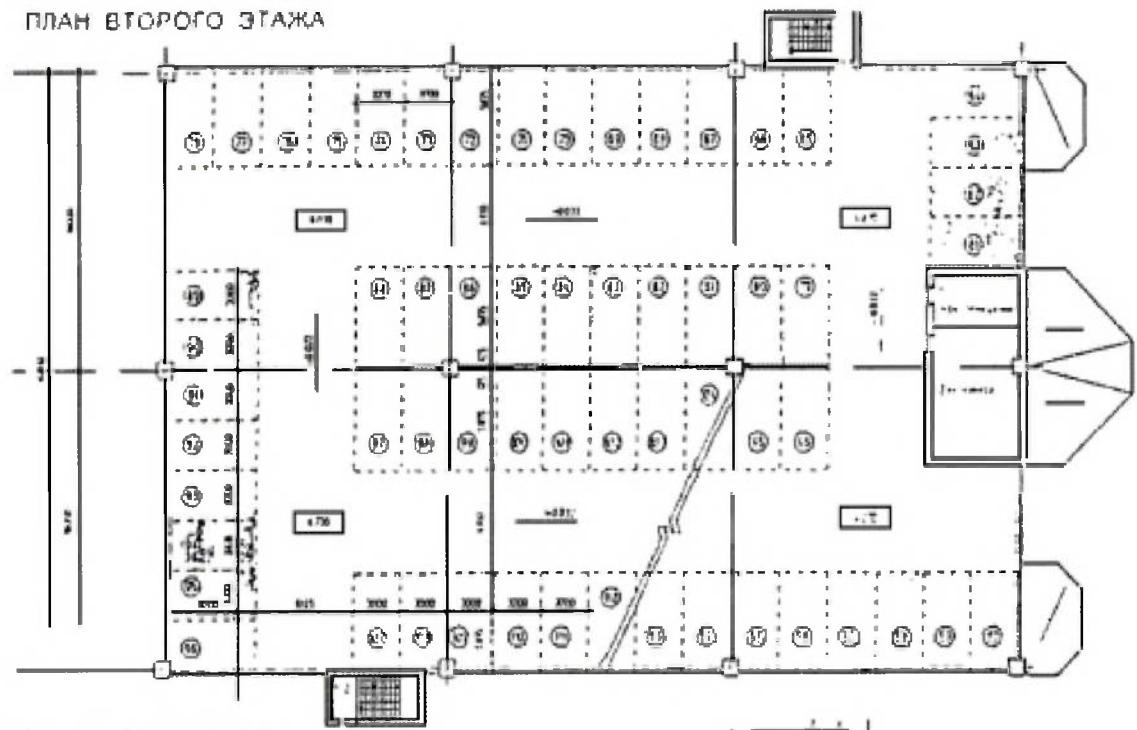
План типового и первого этажа стоянки-гаража
